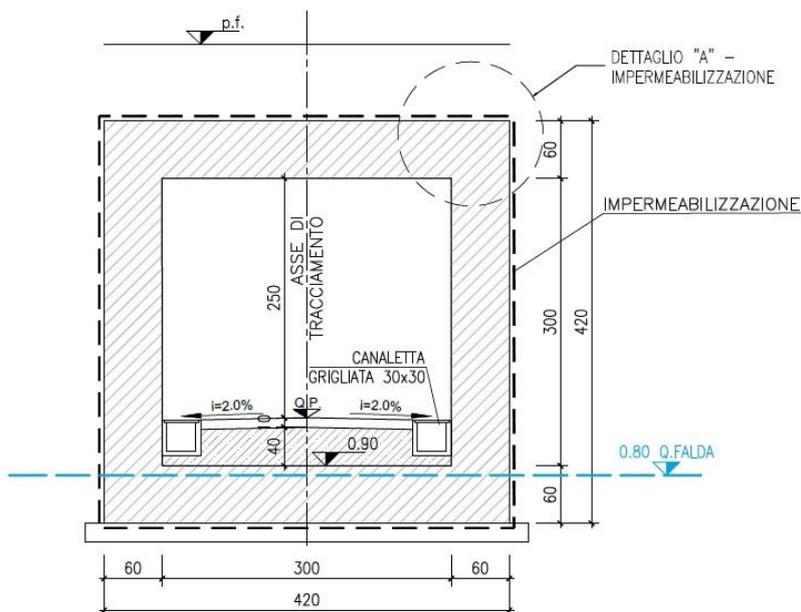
SL02 - Sezione trasversale sottopasso ciclopedonale
